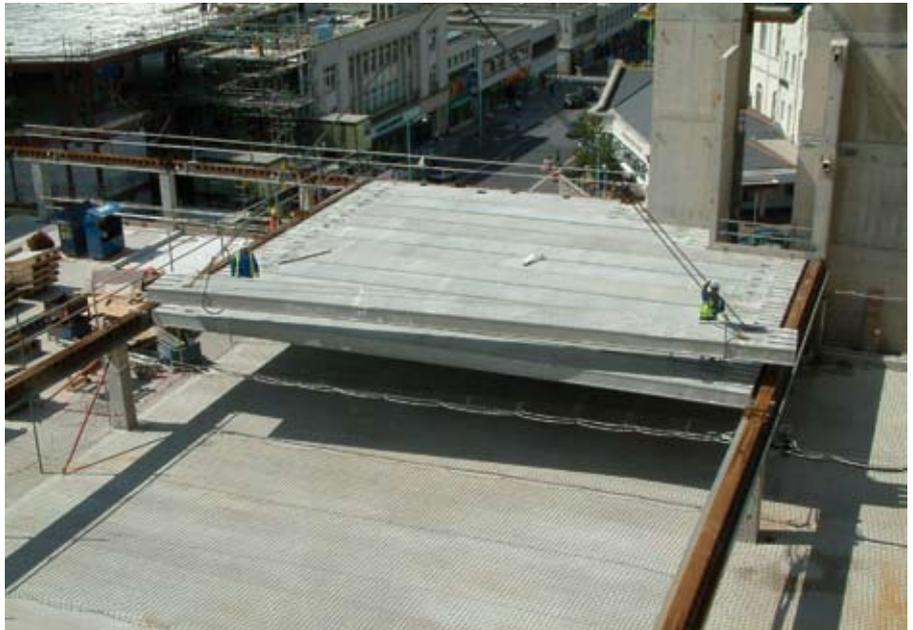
Distancias requeridas para las placas prefabricadas en el forjado
